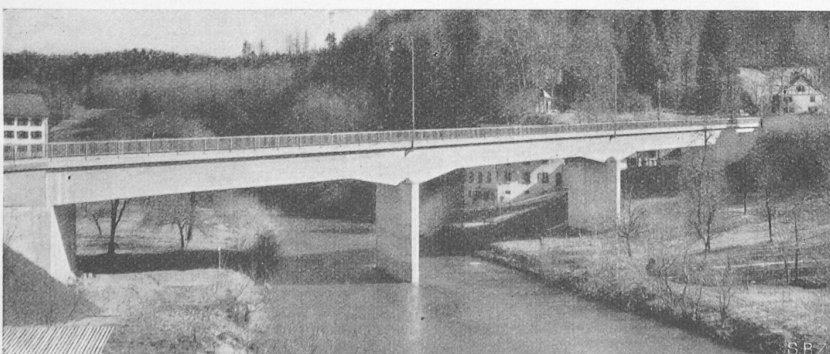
Schiefe, steigende Brücke. Keine Risse in den Trägern
